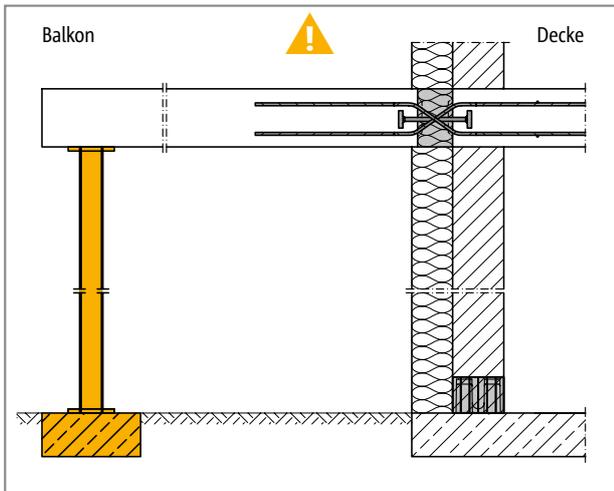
Schöck Isokorb® Typ QPXT+QPXT: Stützung durchgängig erforderlich
